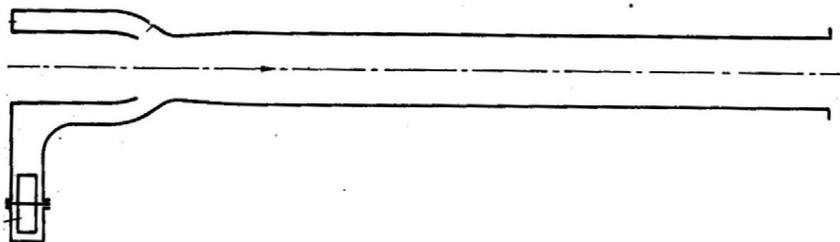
Saccardo-System einer Tunnellüftung [ 3 ]
